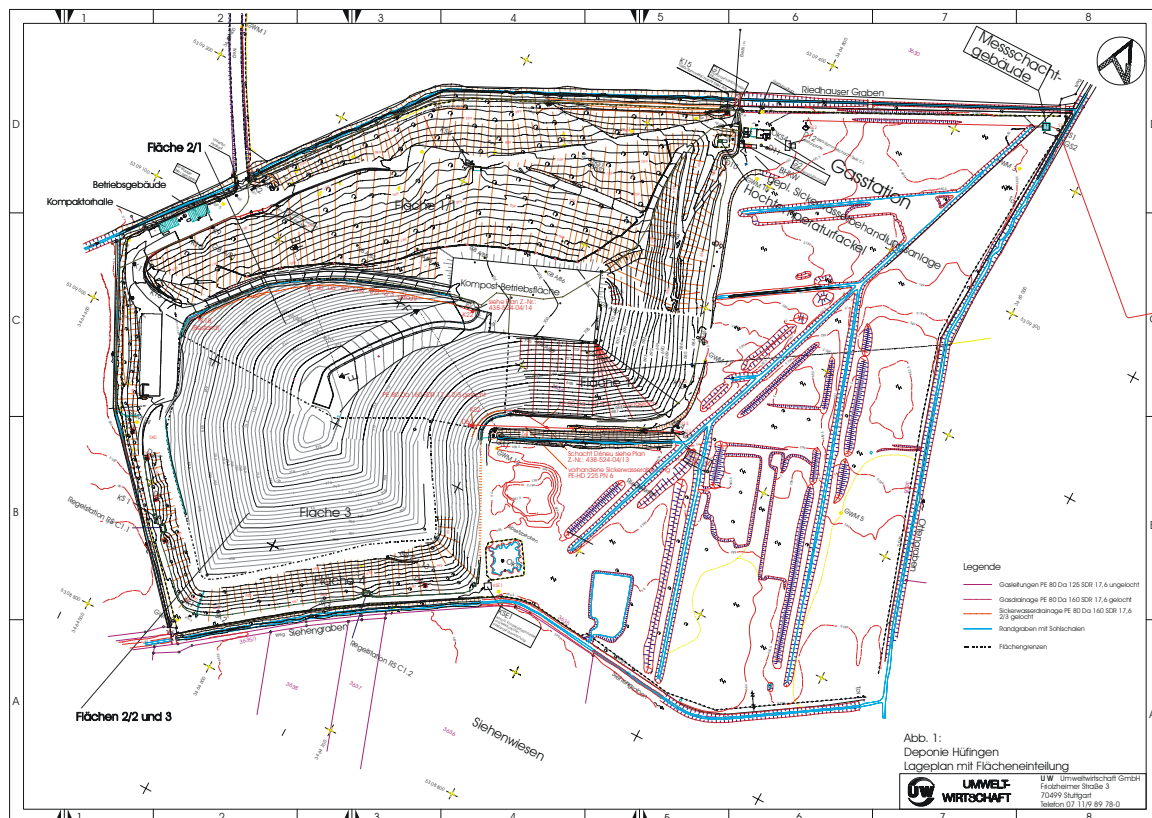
Lageplan Deponie Hüfingen mit Flächeneinteilung
